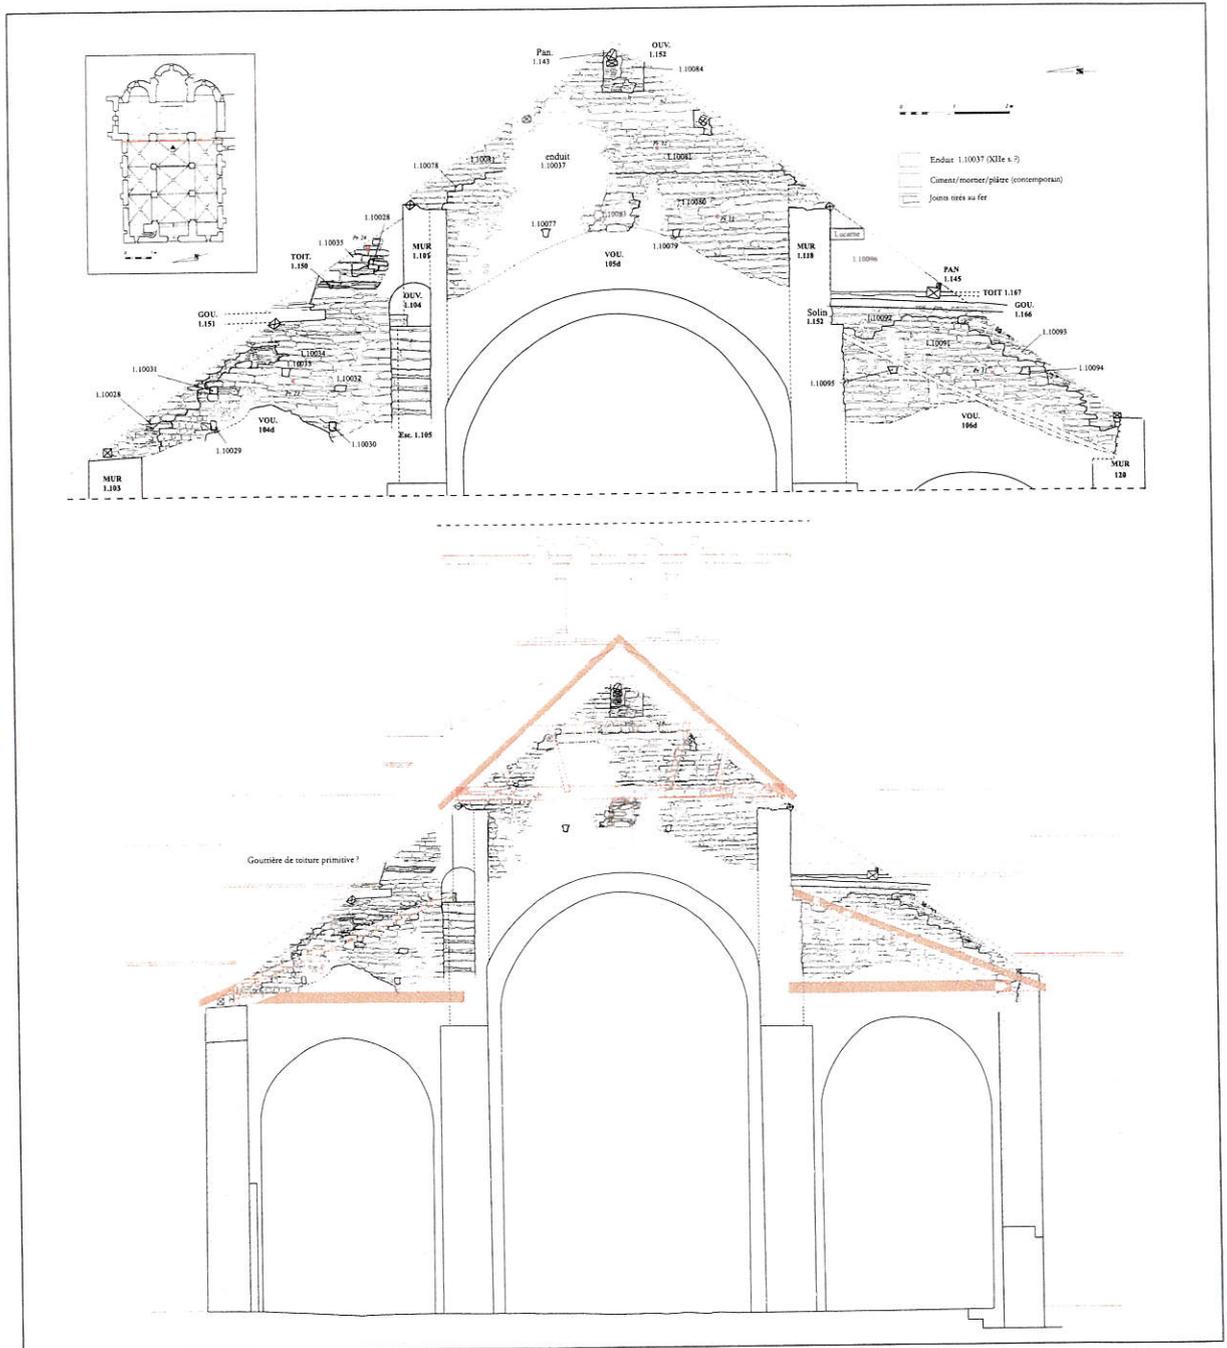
Saint-Lupicin, relevé pierre à pierre et proposition de restitution des toitures au contact entre la nef et le transept (dessin L. Fiocchi d'après S. Bully et équipe de fouille, APAHJ-UMR ArteHis, Dijon)
